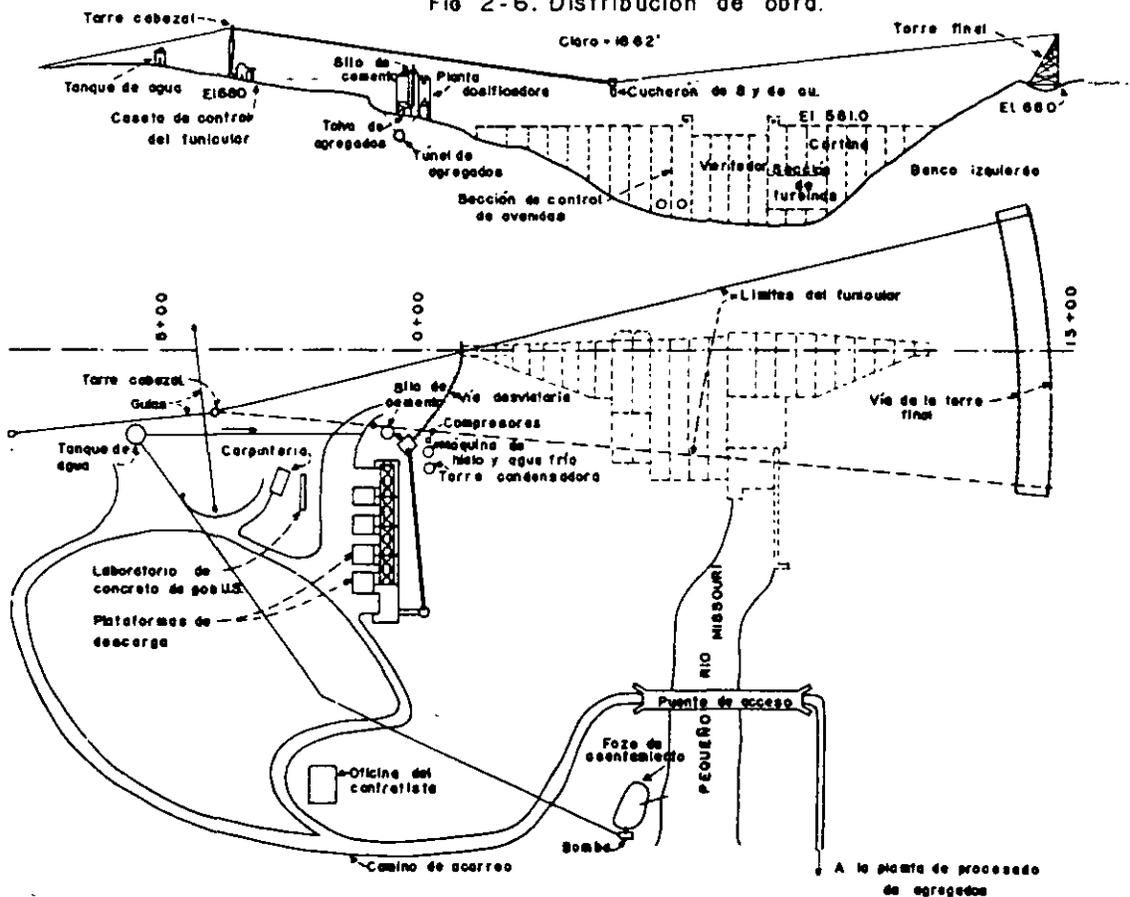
Distribución de la obra para la Presa Narrows. (Engineering News-Record)
